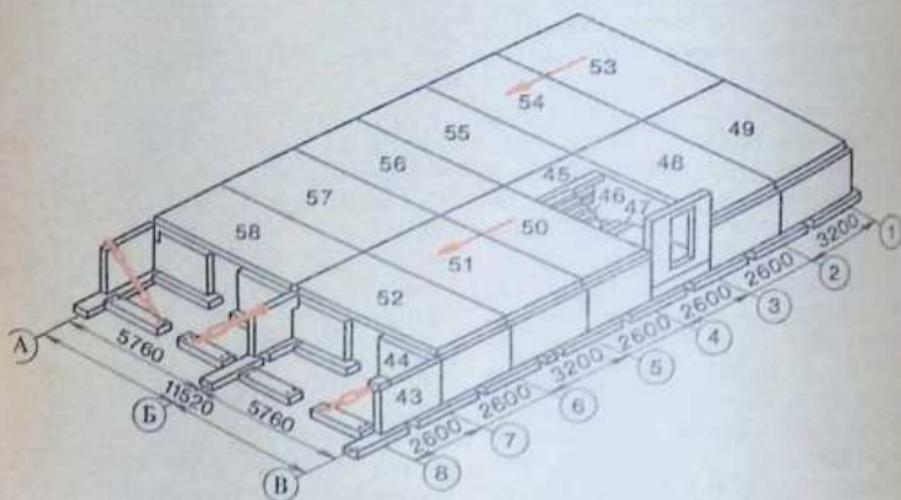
Последовательность монтажа плит перекрытия над подземной частью здания (указана цифрами)
